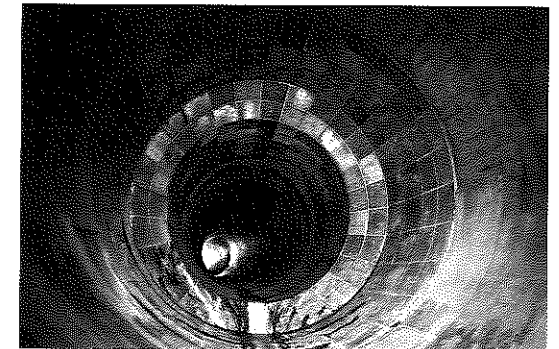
地中接合箇所(手前:内径8.0m,奥:内径6.5m)
